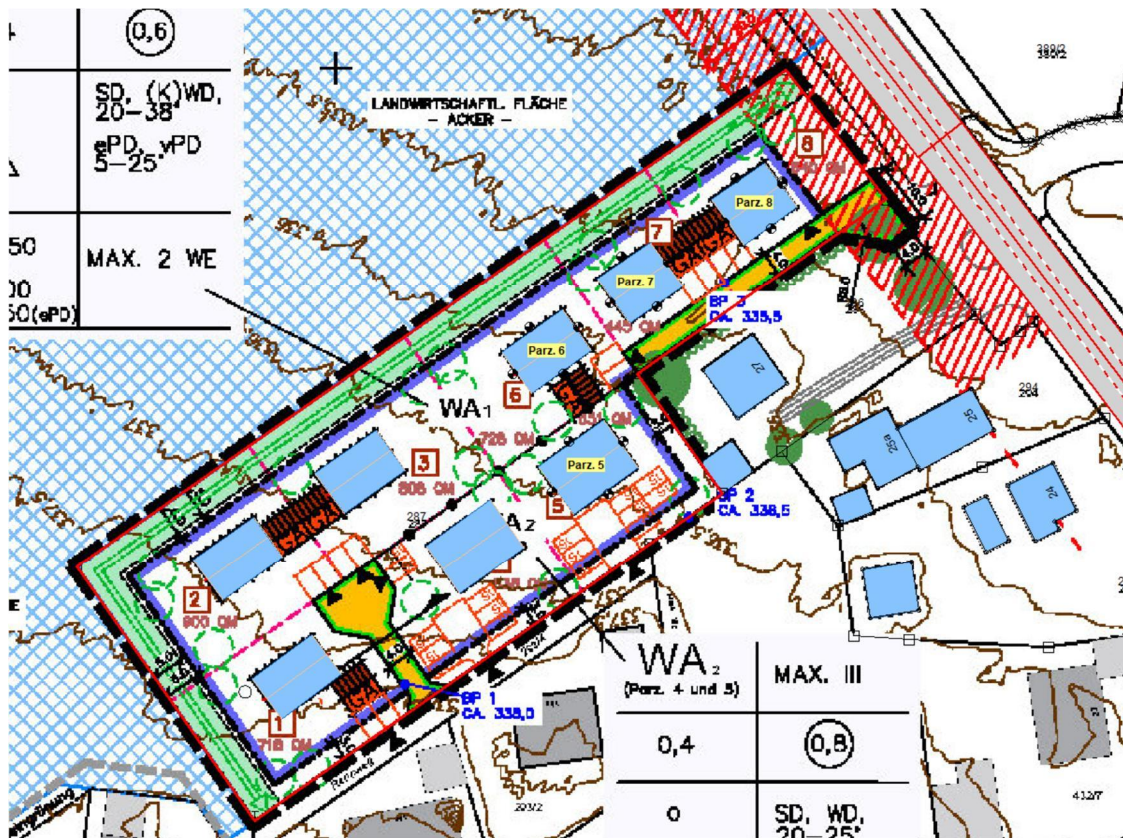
Lageplan mit Kennzeichnung der Immissionsorte Gebäudefassaden
